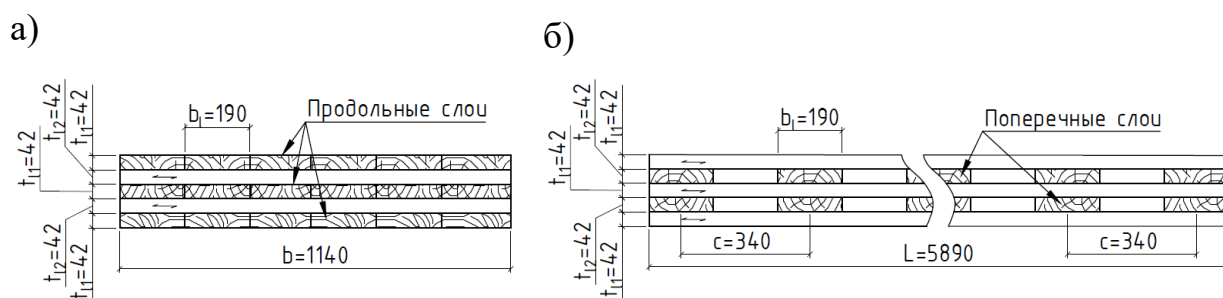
Пятислойная плита перекрытия из ДПК с шагом в поперечном слое $c=340$ мм
